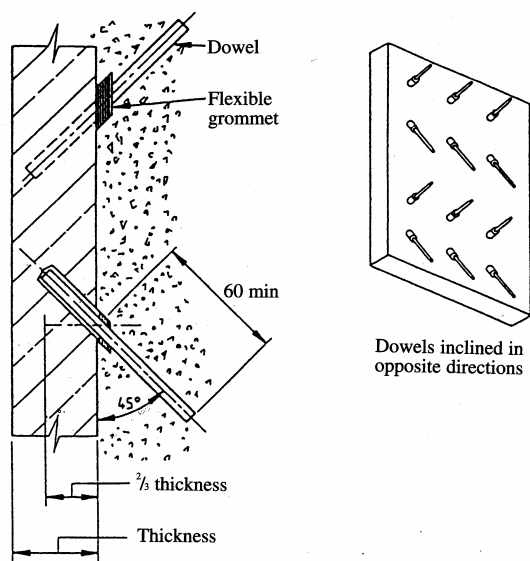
Exemplo de fixadores e layout de painel com aplicação de granito
